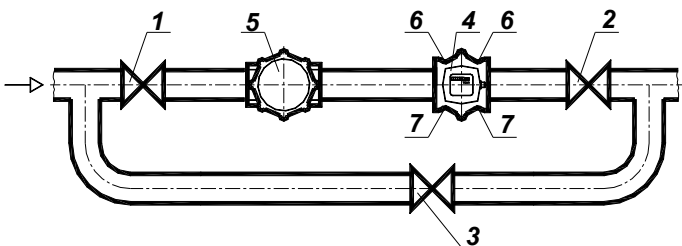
Схема монтажа счетчика (с байпасом) на горизонтальном газопроводе
